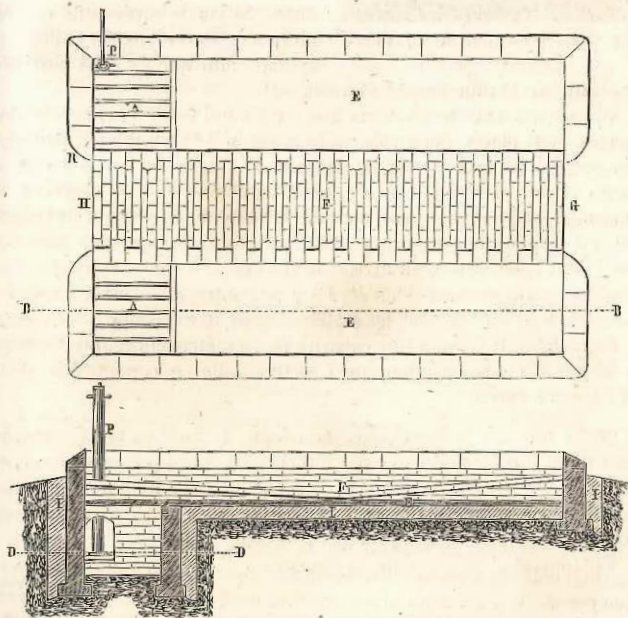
Plan et coupe de la fumière de M. Boussingault.
